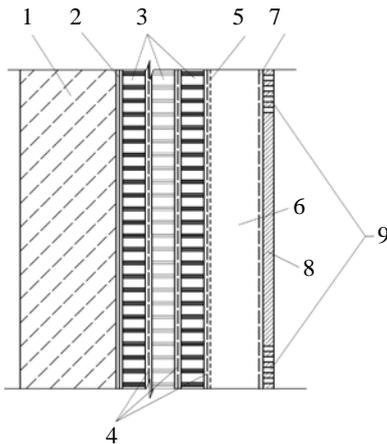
Вертикальное сечение фрагмента стеновой панели
